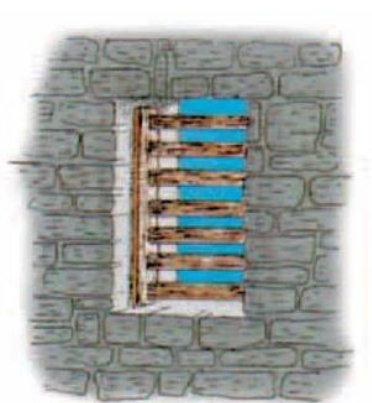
Aménagement d'une chiroptière laissant passer les chiroptères tout en évitant l'installation des pigeons © Fairon, 2003
